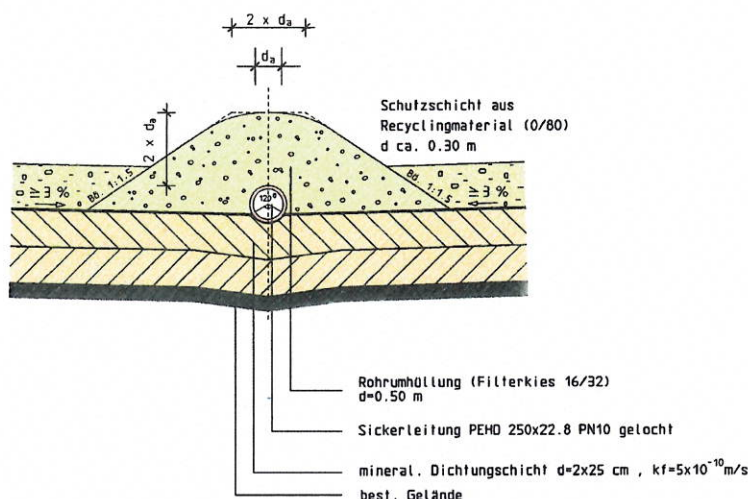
Einbau Da 250 Rohre gemäß 1.5
